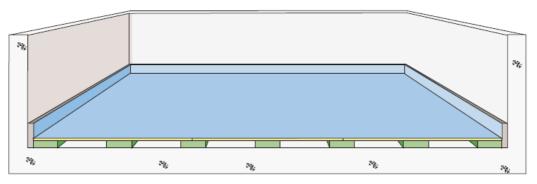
Dérouler le polyane (membrane pare-vapeur) sur les panneaux de coffrage en tenant compte de 300mm de recouvrement et d'un assemblage par bande autocollante.
